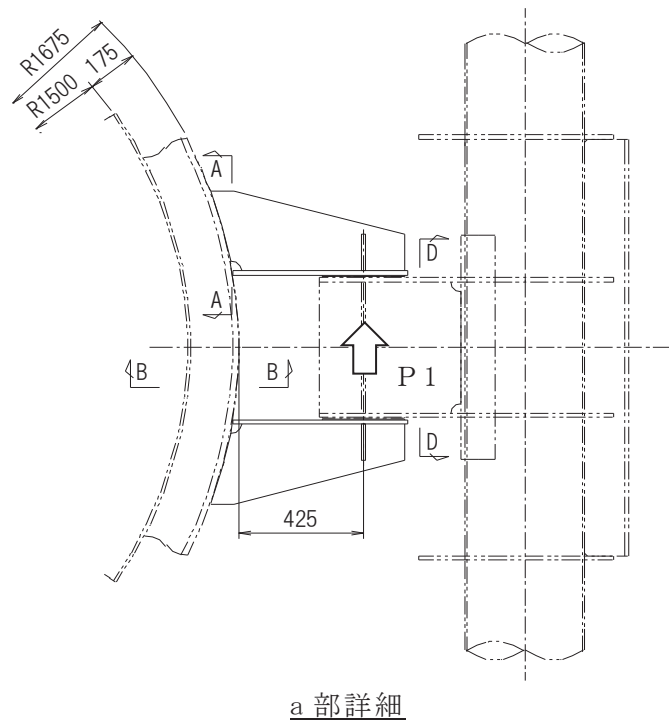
(1) 第 1 支持点部の支持金物の平面図及び支持点荷重図 (単位 : mm)
